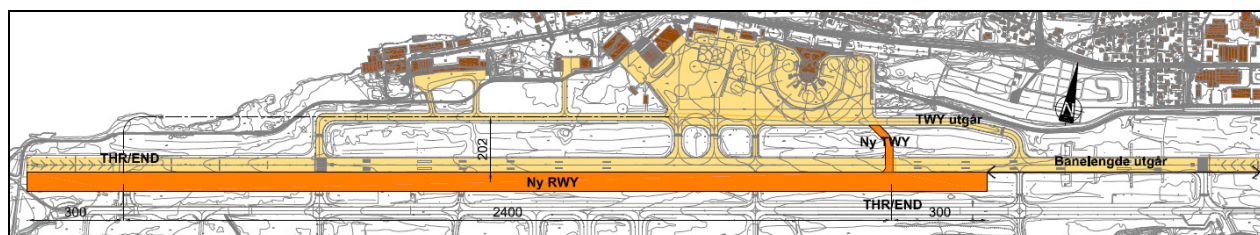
Reasfaltering eller fornying av eksisterende rullebane
